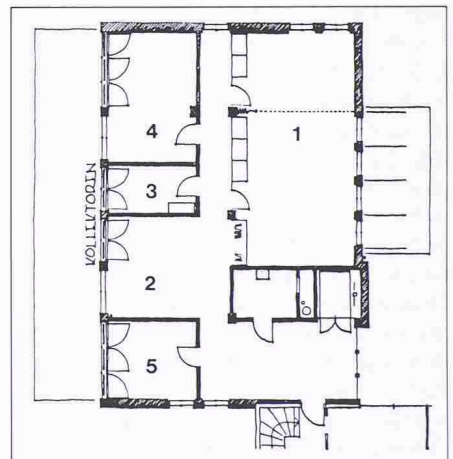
Grundriss Obergeschoss; 1 Besprechung, 2 Ausstellung, 3 Labor, 4 Reproraum, 5 Messraum
